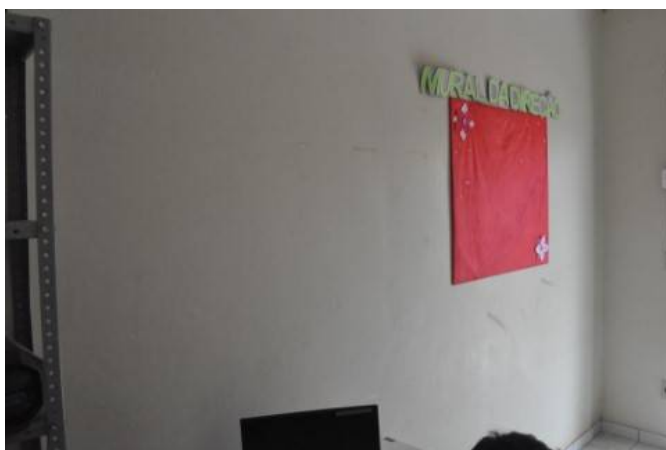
Vista geral: Parede direita almoxarifado.
